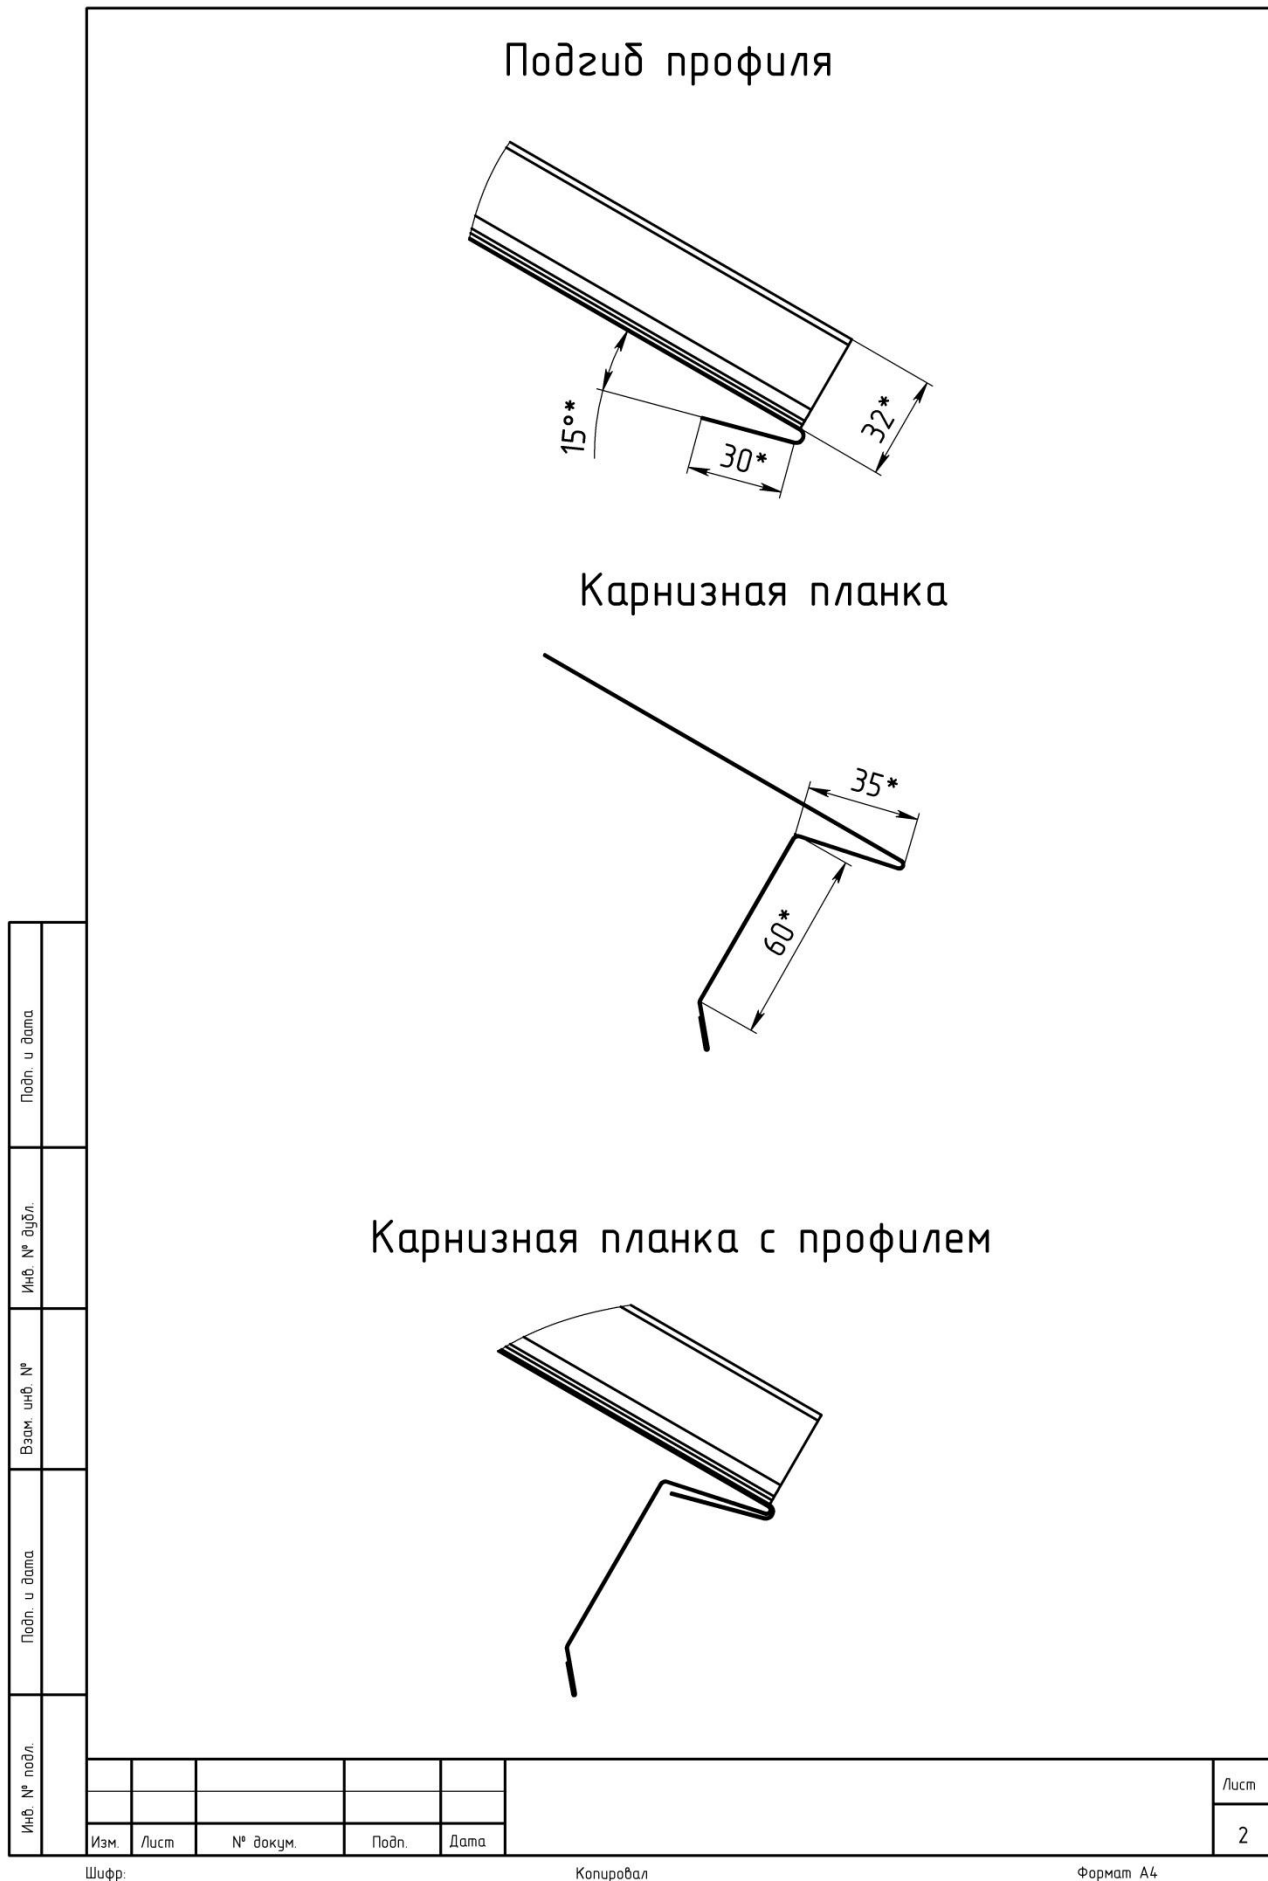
Сборочный чертеж профиля кровельной панели и профиля карнизной планки
